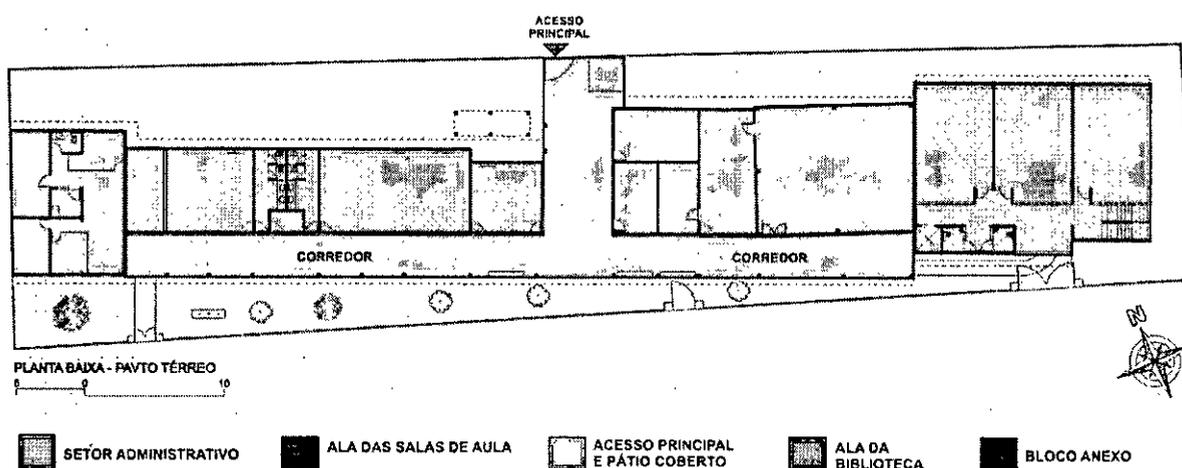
Setorização da Unidade Penedo. Elaboração: Equipe Técnica do Plano Diretor
